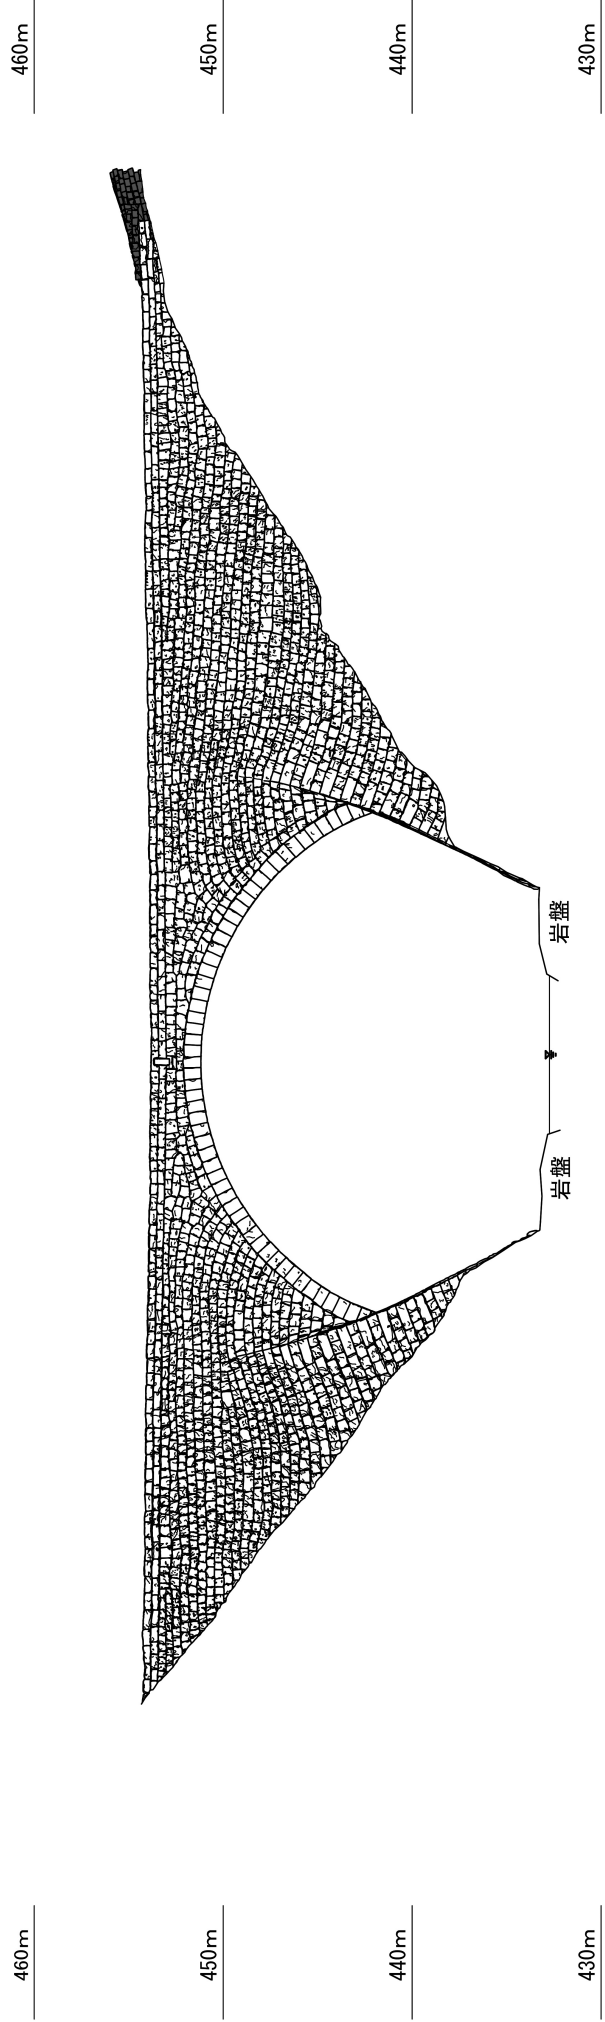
通潤橋石堰下流側立面图 (S=1/400)
